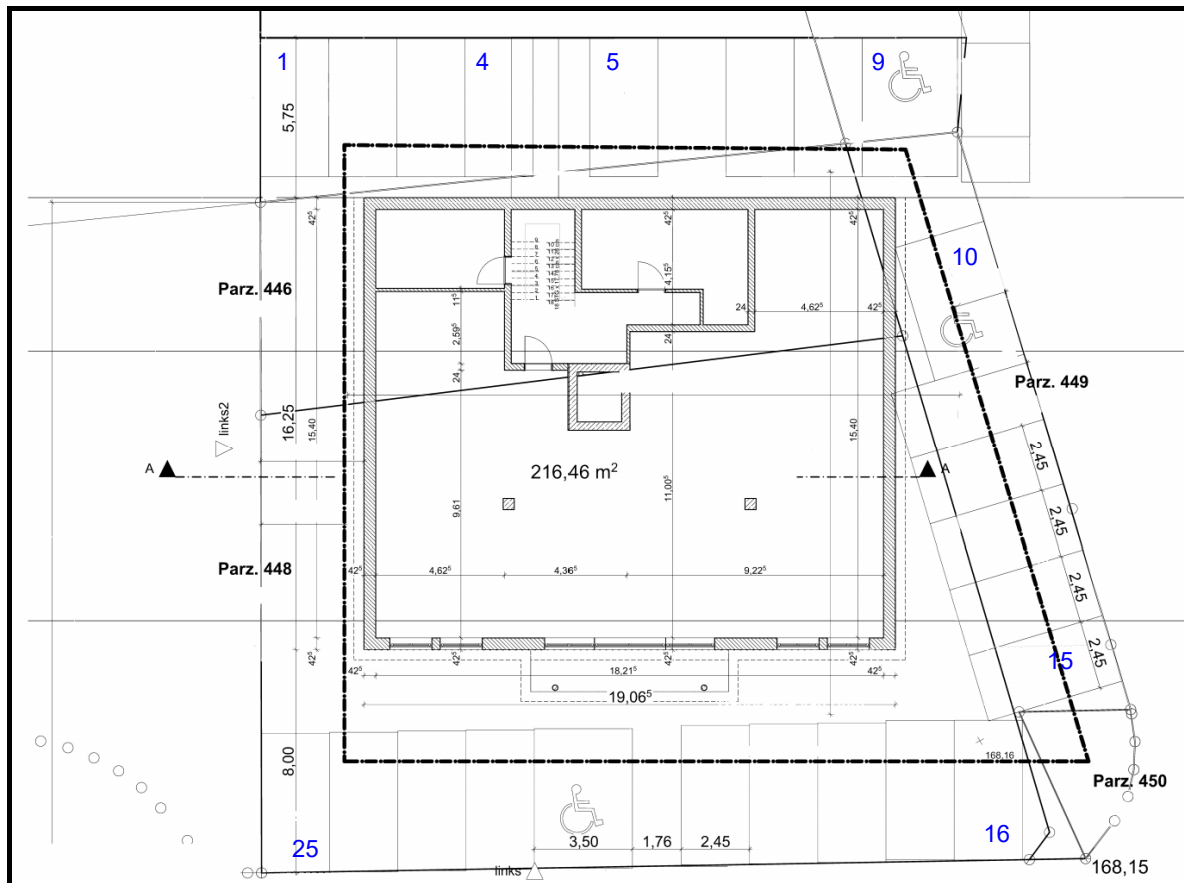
Lage der Pkw-Stellplätze des geplanten Ärztehauses
